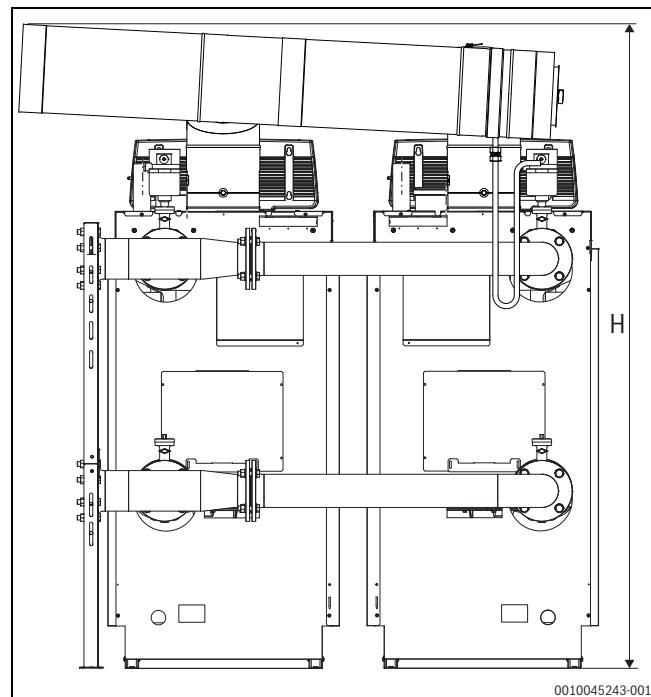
2-Kessel-Kaskade über dem Kessel (Rückansicht)
